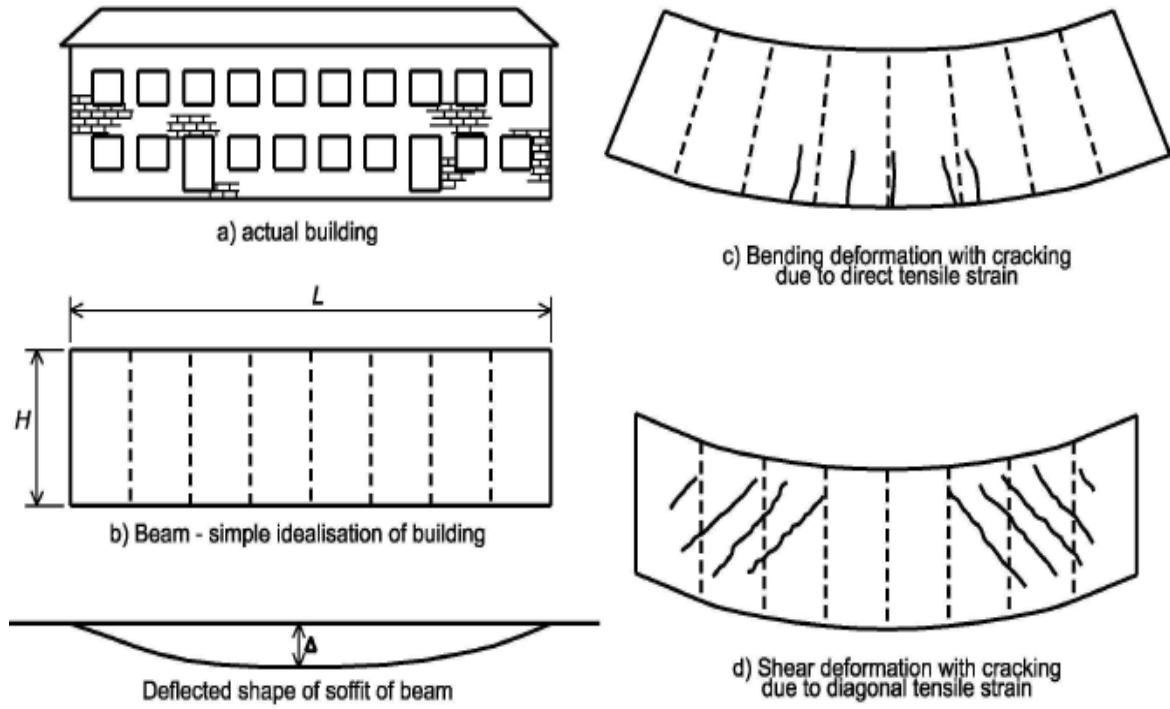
Fisuración de una viga simple sometida a flexión y cortante Burland, J.B., Wroth, C.P. (1974)
